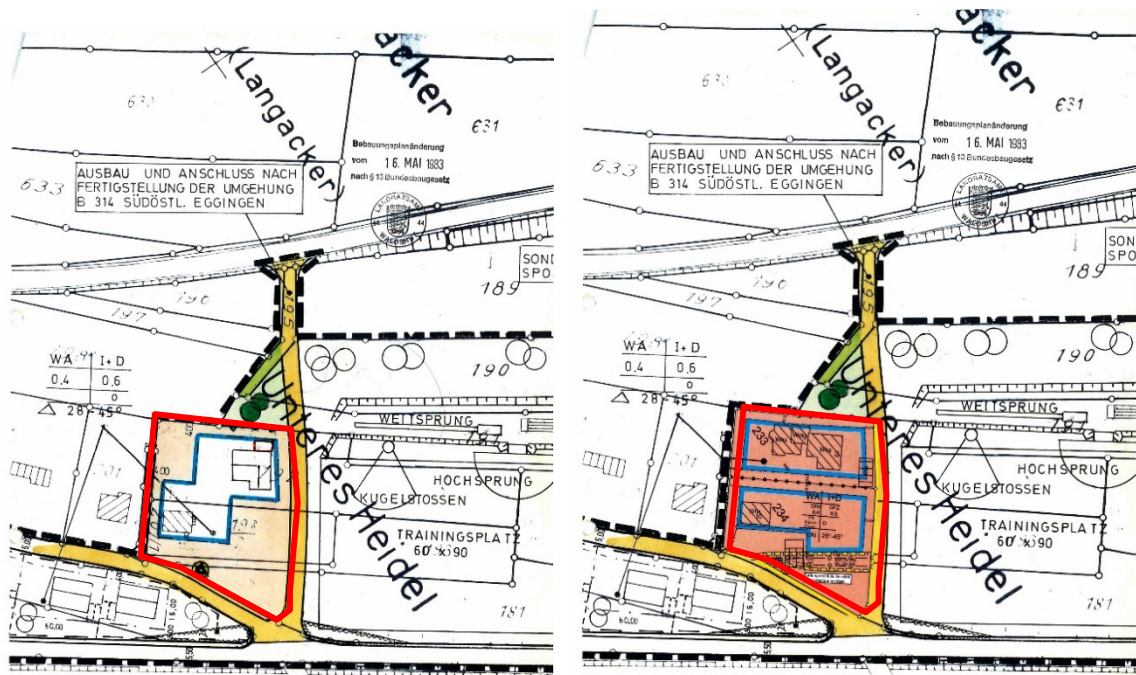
Ausschnitt aus Bebauungsplan „Unteres Heidel“; links: Rechtskräftige Planfassung (2. Änderung) 1988, rechts: Entwurf zur 3. Bebauungsplanänderung (Quelle: GEOplan); rot: Plangebiet
